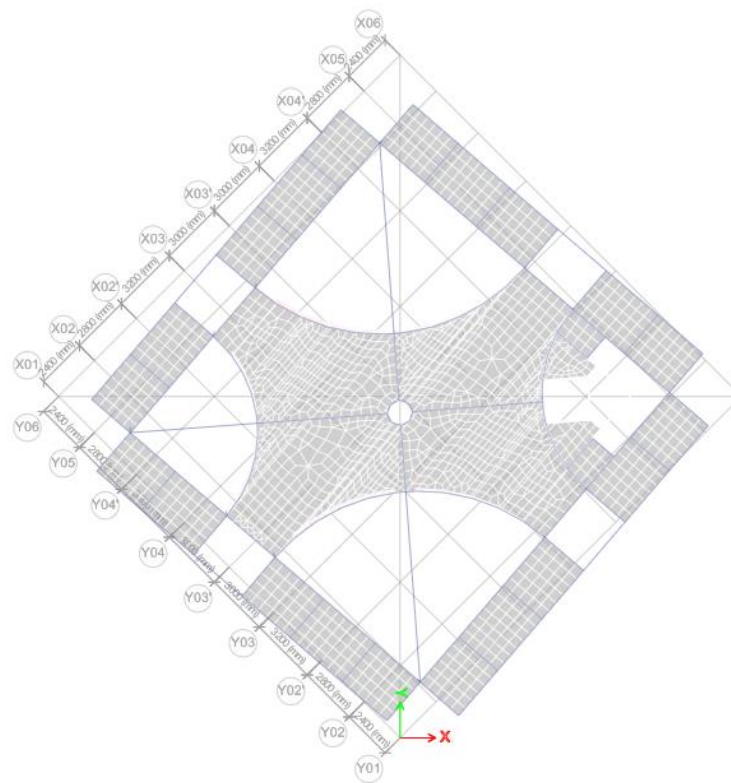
Vista en planta deformada nivel 5 (Modo 2)
